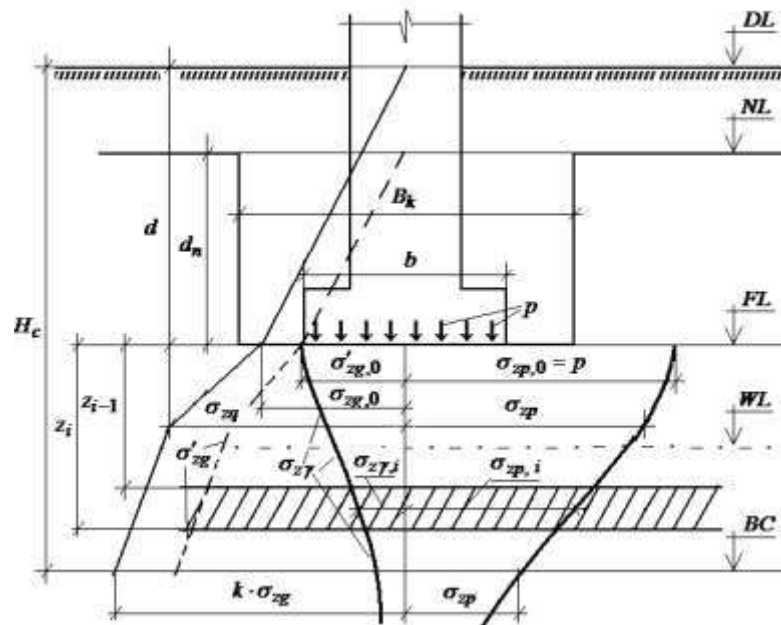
До визначення осадки окремого фундаменту: NL – позначка природнього рельєфу; DL – те ж саме, планувальна; FL – позначка закладення подошви фундаменту; WL – те ж саме, рівня підземних вод; BC – нижня границя стискуваної товщі; d і d_n глибина закладення подошви фундаменту відповідно від рівня планування і природнього рельєфу; b і B_k – відповідно ширина подошви фундаменту і котловане; p – середній тиск під подошвою фундаменту; σ_{zg} і $\sigma_{zg,0}$ – напруження від власної ваги ґрунту на глибині z і позначка закладення подошви фундаменту відповідно при проєктній позначці денної поверхні основи – DL ; σ'_{zg} і $\sigma'_{zg,0}$ – те ж саме, але при позначці природнього рельєфу (тобто NL); σ_{zp} і $\sigma_{zp,0}$ – нормальні вертикальні напруження від зовнішнього навантаження на глибині z і позначці закладення подошви фундаменту відповідно; $\sigma_{z\gamma}$ – напруження від власної ваги ґрунту, що виникають при відривки котловану
